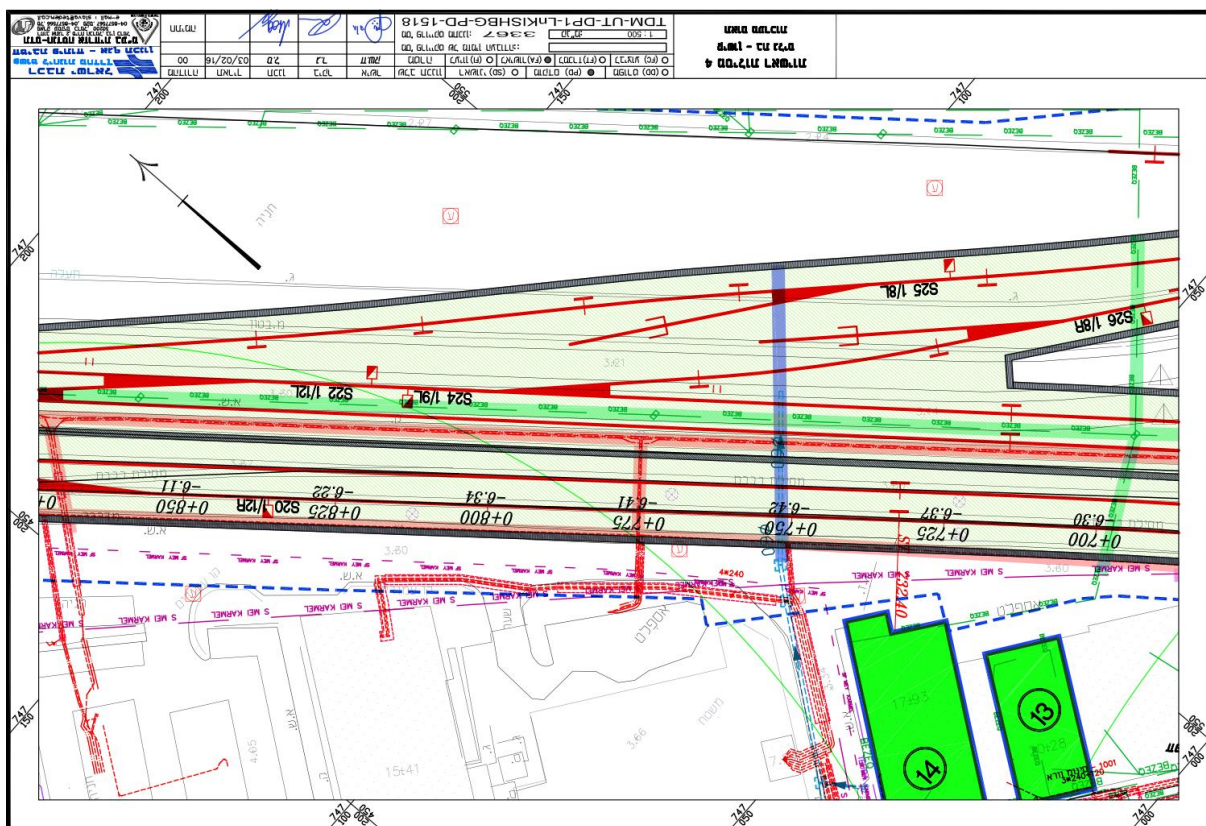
Geplante Position von Schutzweichen im Tunnelbereich
